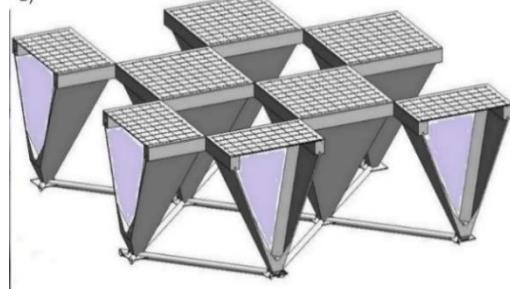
Гибридное структурное покрытие с пирамидальными элементами со стальфибробетонными гранями и железобетонными основаниями, закреплёнными к растянутому поясу. BIM модель гибридной конструкции покрытия
